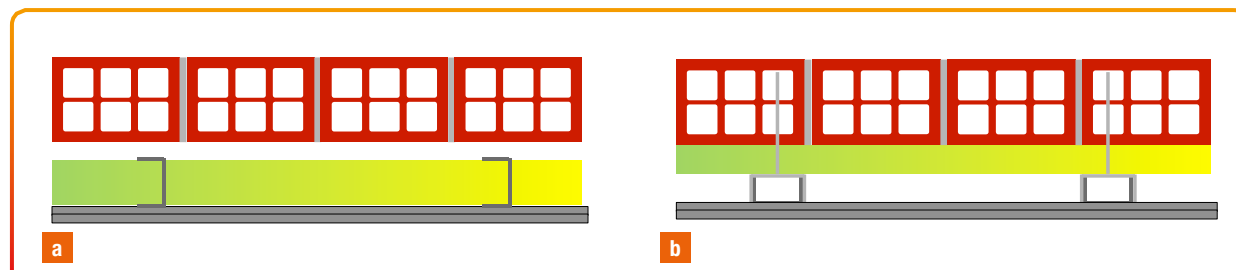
a) Controparete su struttura autoportante (può essere staccata dalla parete in quanto i montanti metallici sono alloggiati all'interno di guide metalliche fissate a pavimento e soffitto). b) Controparete collegata alla parete esistente mediante supporti (distanziatori) ancorati alla struttura stessa.
